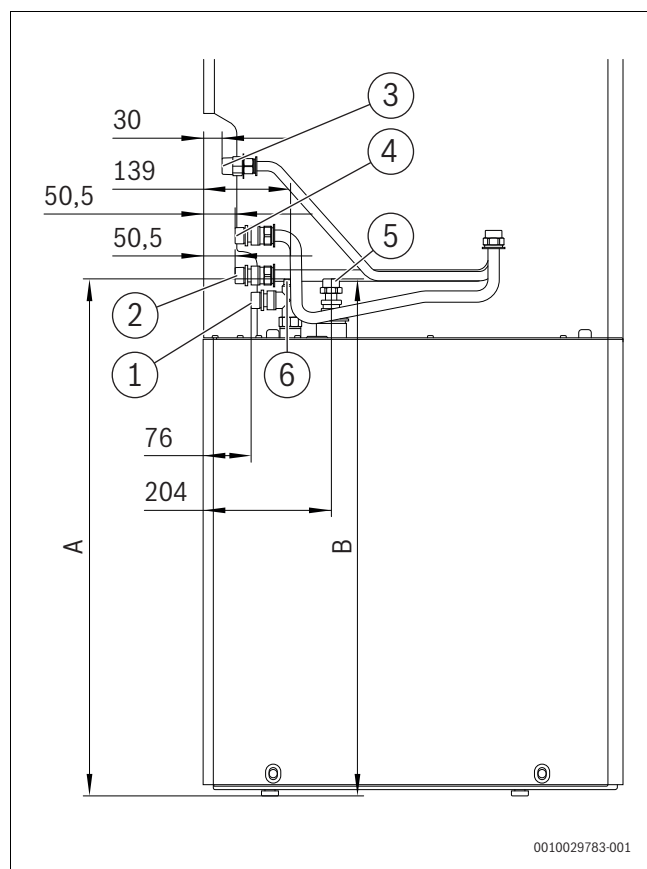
Pohled ze zadní strany (rozměry v mm)
